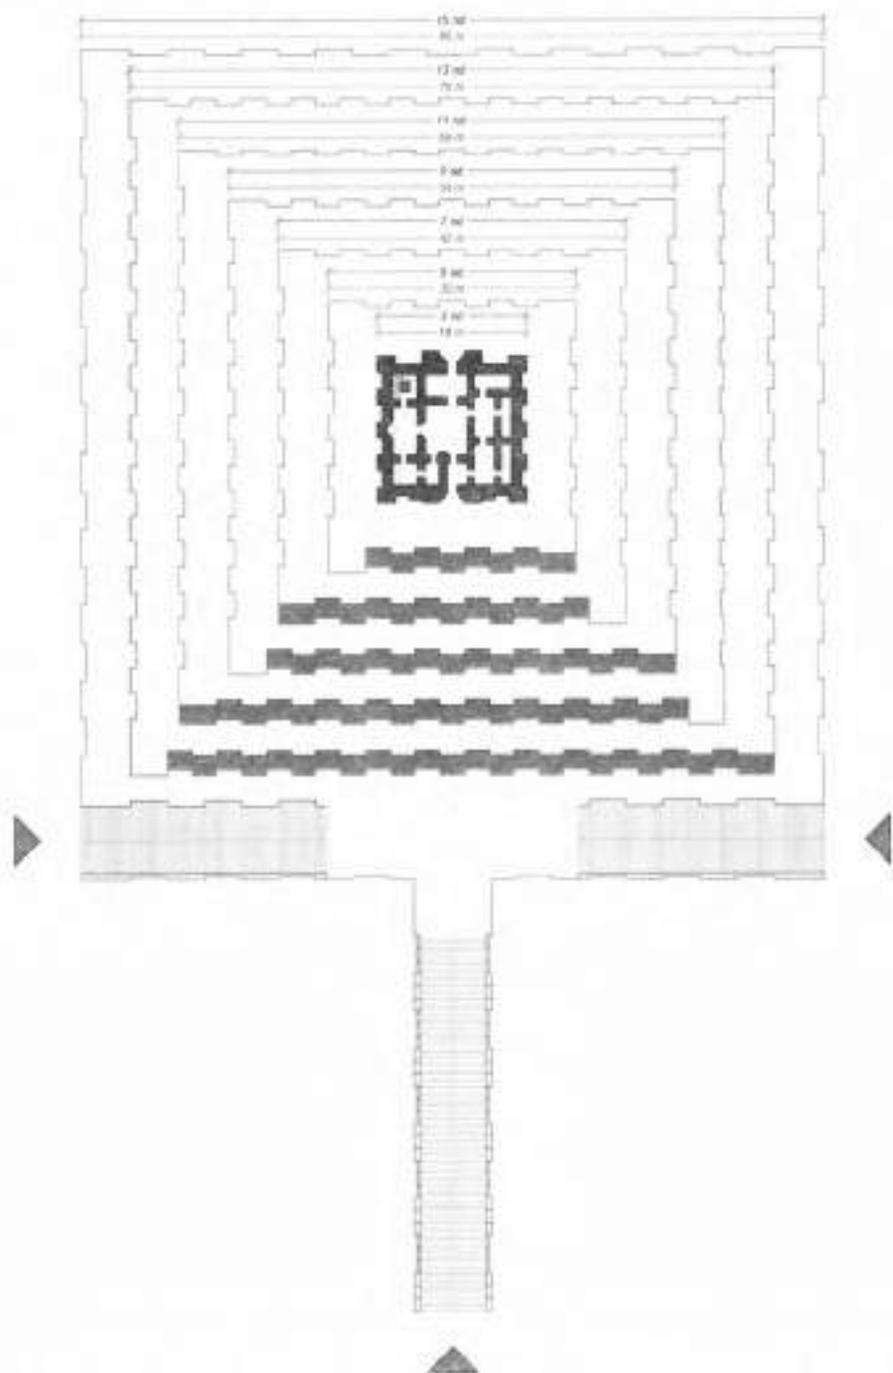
Planta da torre de Babel. Hipótese A: acesso em zigzag na fachada principal.
